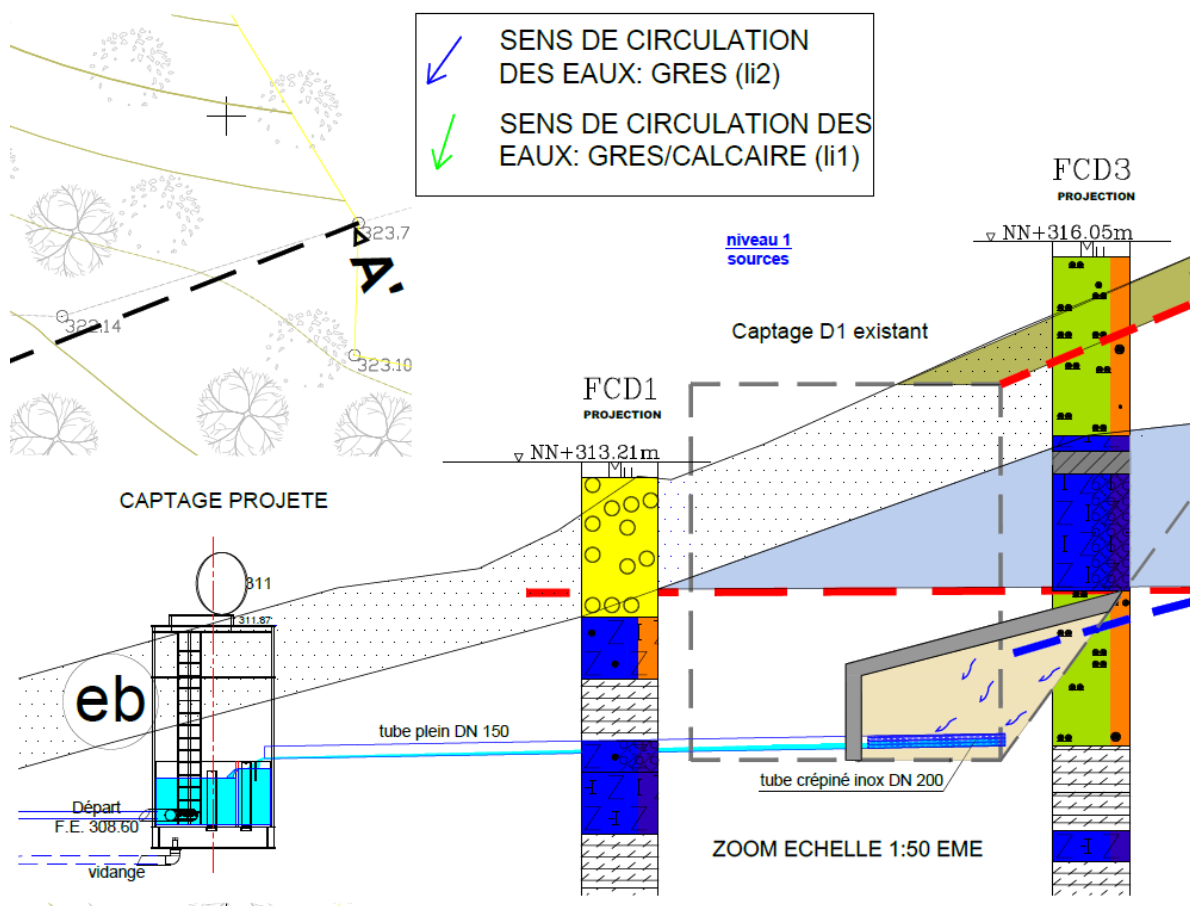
Plan schématique „Captage D1 Dommeldange- Concept d'assainissement (AVP)“, Coupe, Détail 2 (Géoconseils 2014)
